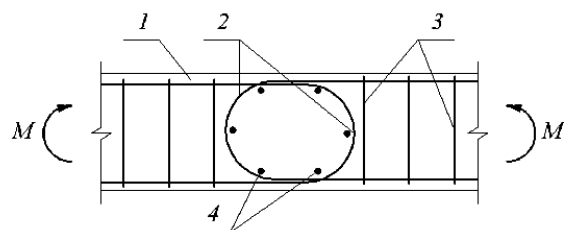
Возможные варианты количества бетонных ядер петлевых стыков арматурных стержней при двухрядном армировании:
